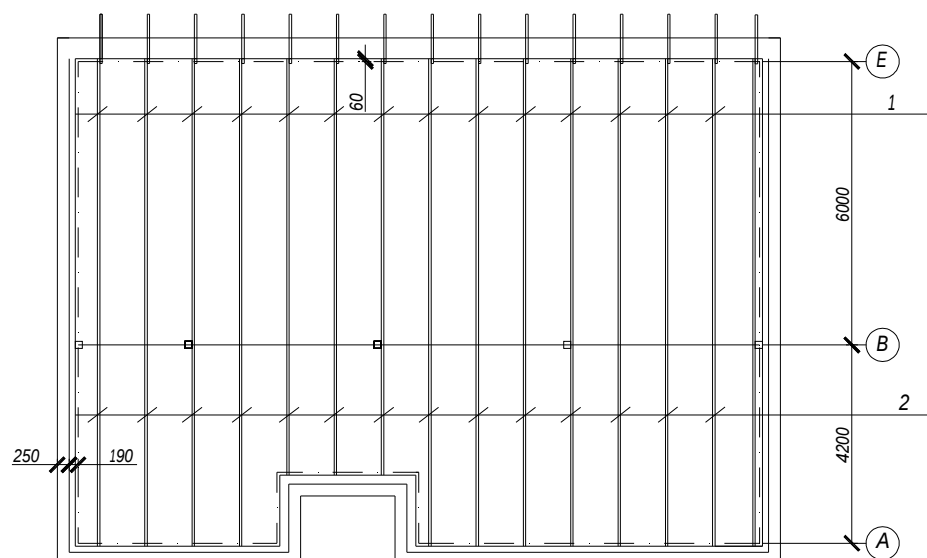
Схема балкового перекриття двохкімнатного житлового будинку
